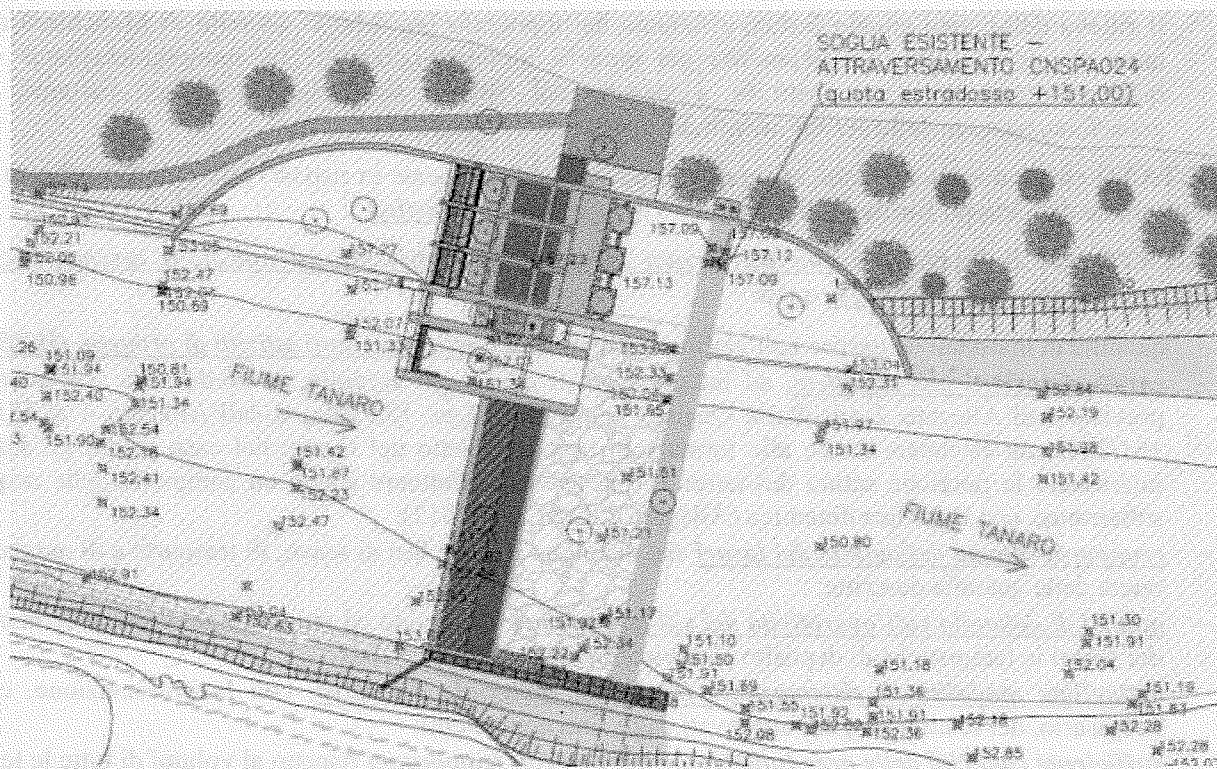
Planimetria dell'impianto in corpo traversa: soluzione alternativa localizzata presso un attraversamento esistente in sub-alveo.
